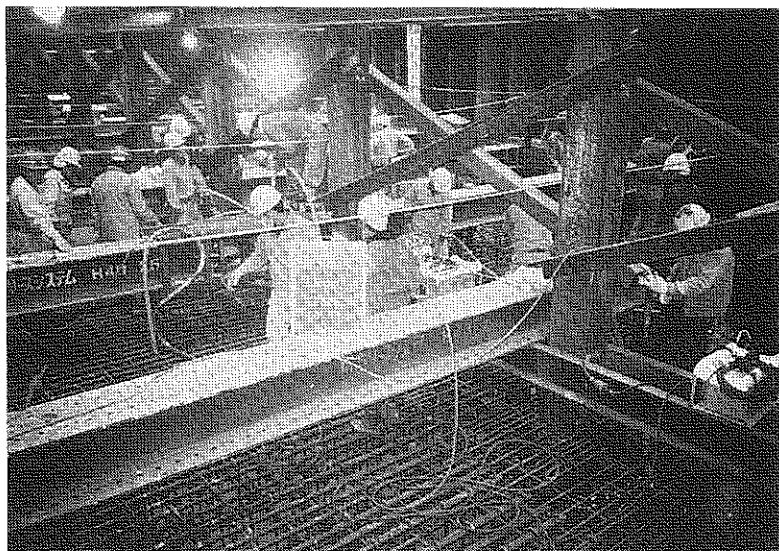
6 - 35 く体鉄筋コンクリート打設状況
